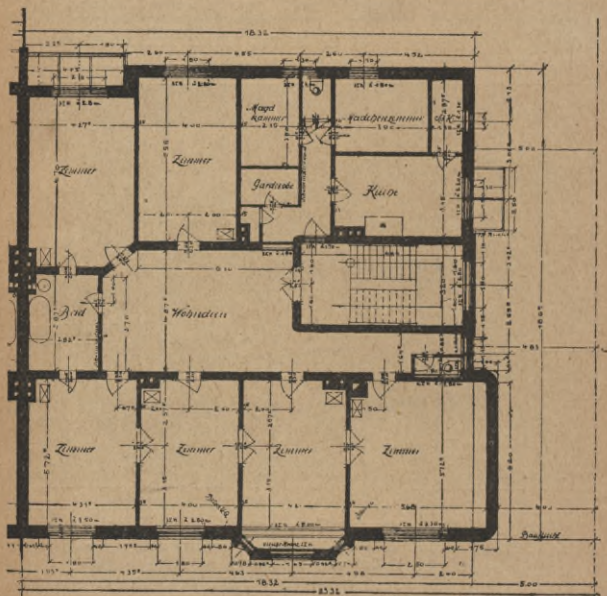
Wohnhaus Trautenwolfstraße, München.
